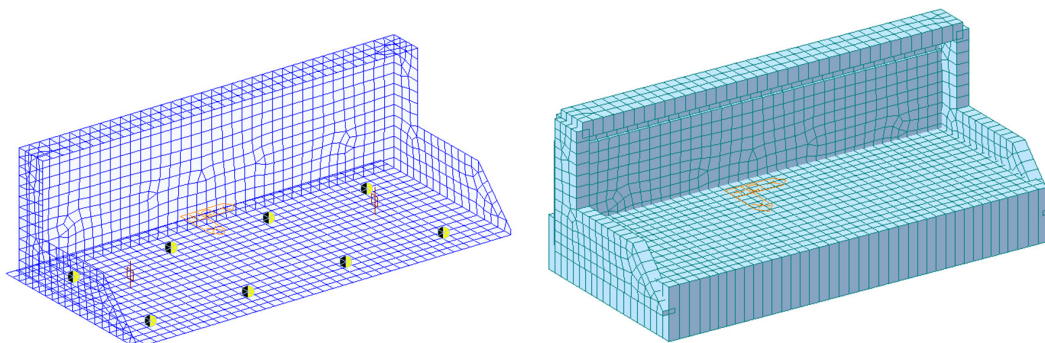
Modello di calcolo (vista wireframe e vista estrusa)
